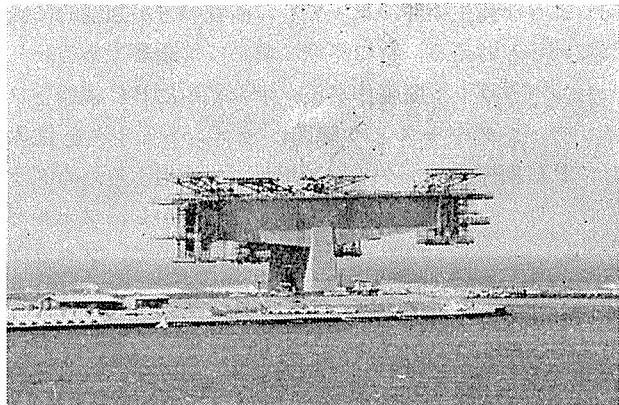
大型ワーゲンによる P<sub>4</sub> 橋脚からの
